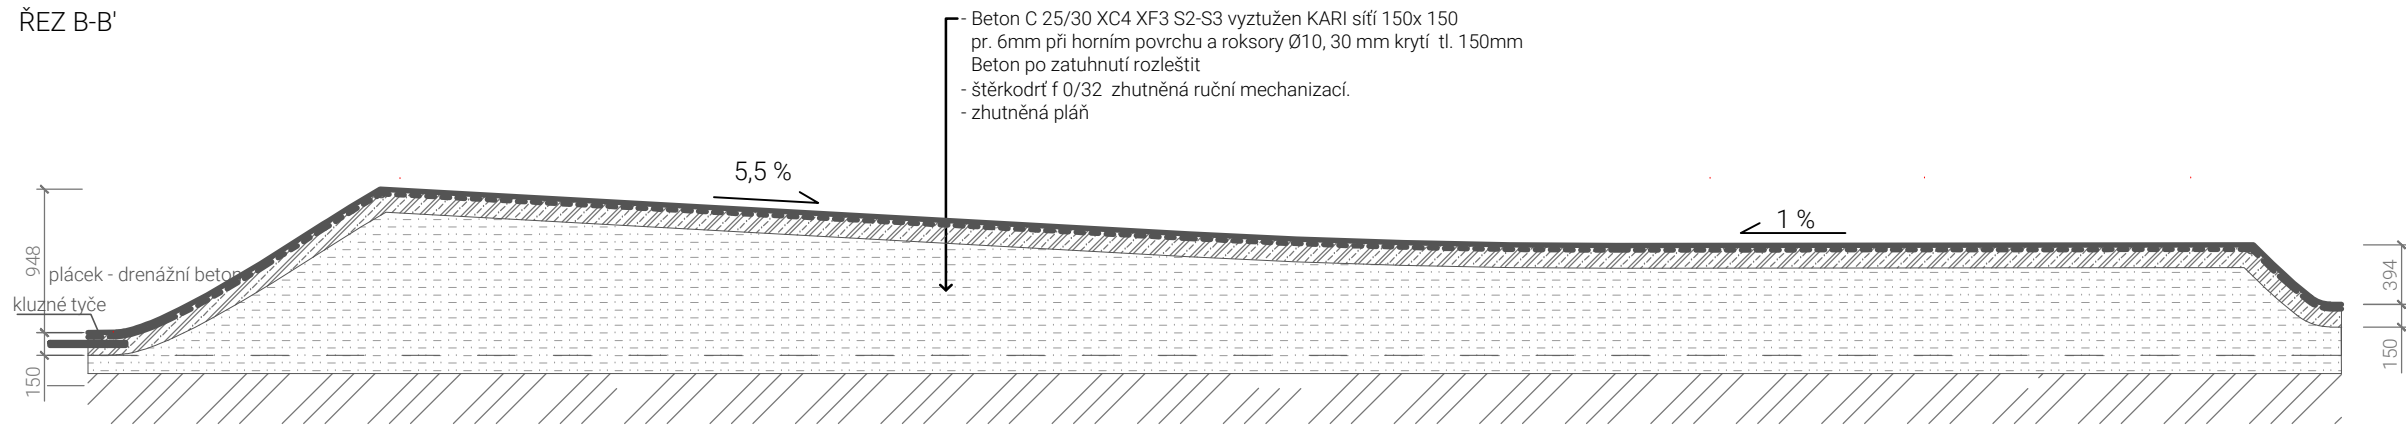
DETAIL ŘEŠENÍ BETONOVÉHO PRVKU
